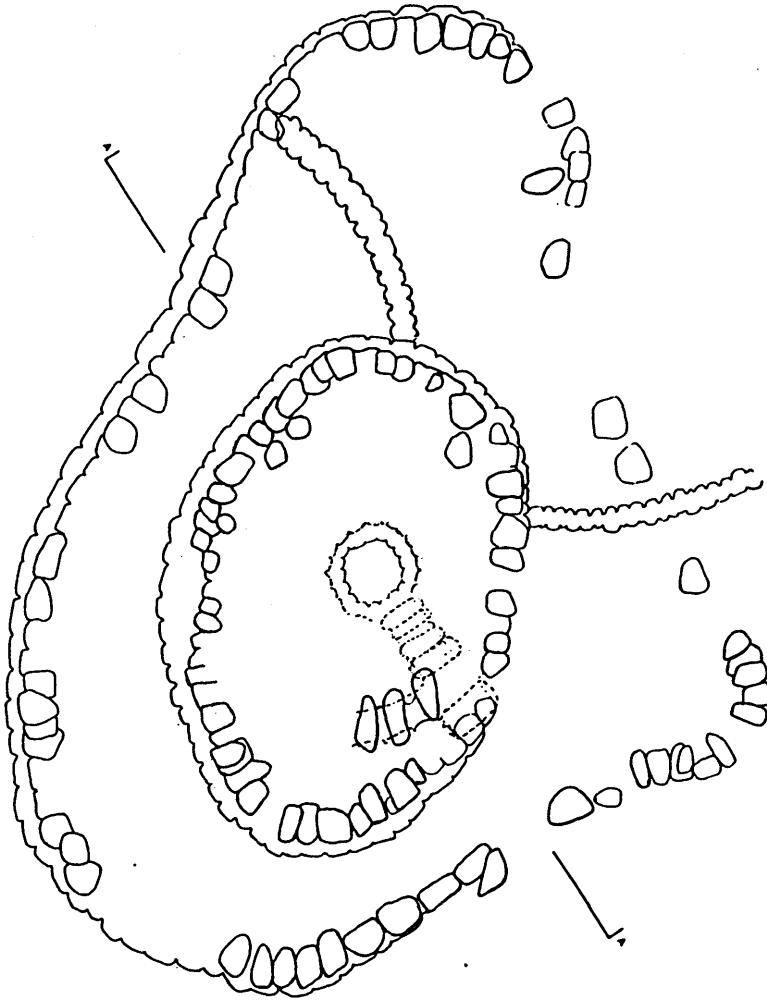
Nuraghe Sa Craccara: planimetria e sezione.
